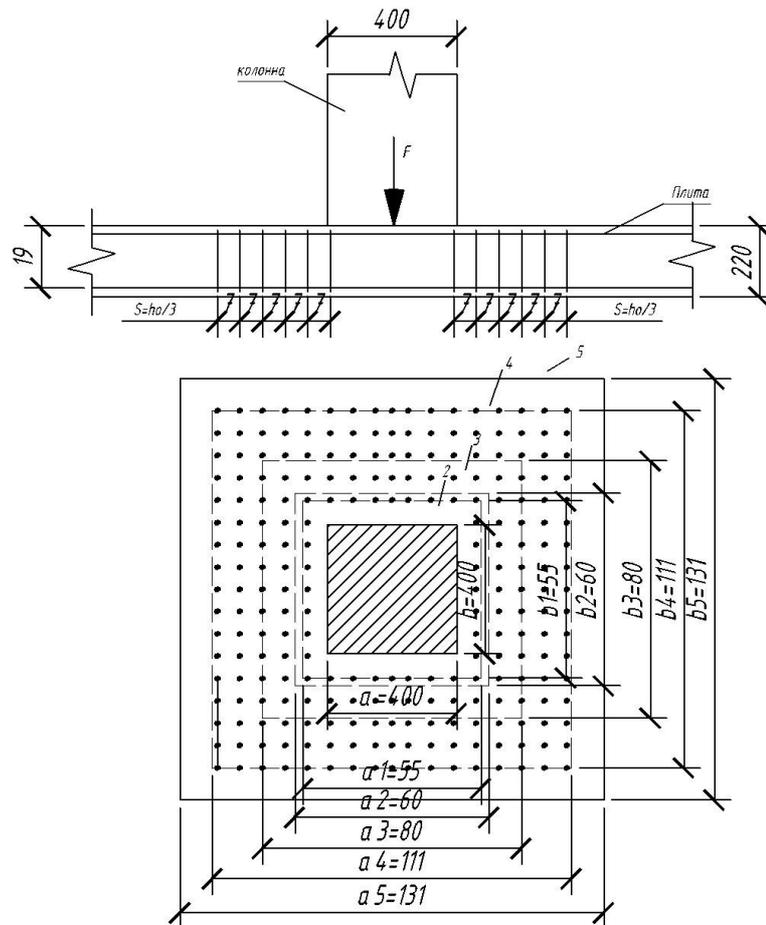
Схема для расчета железобетонных плит с вертикальной, равномерно распределенной поперечной арматурой на продавливание
